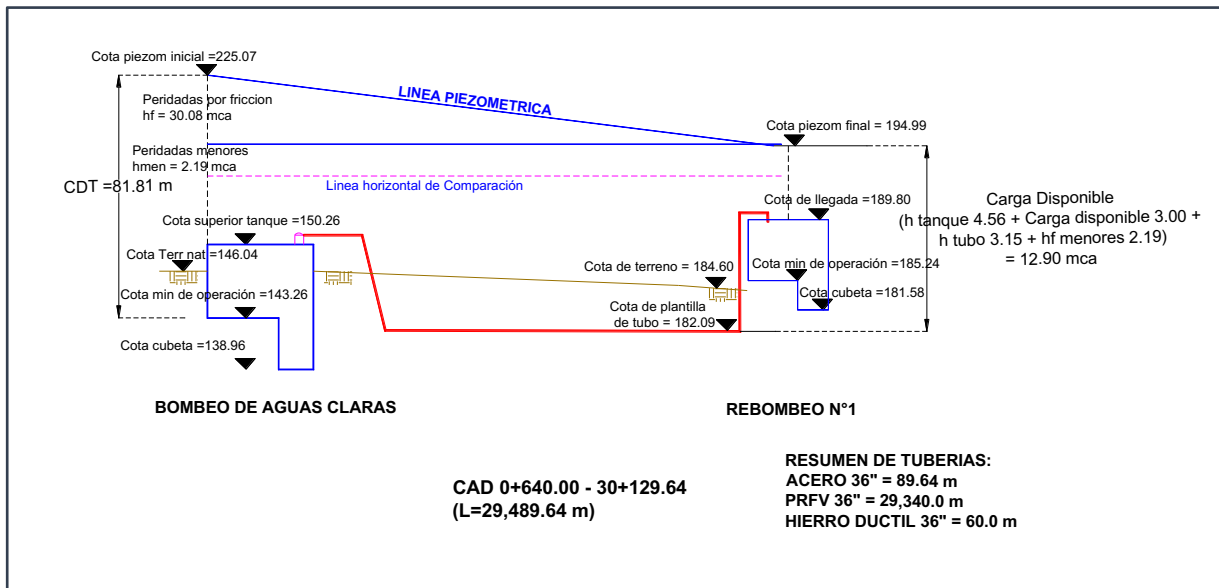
Piezométrica de la planta potabilizadora al rebombero No. 1, Alternativa 1
